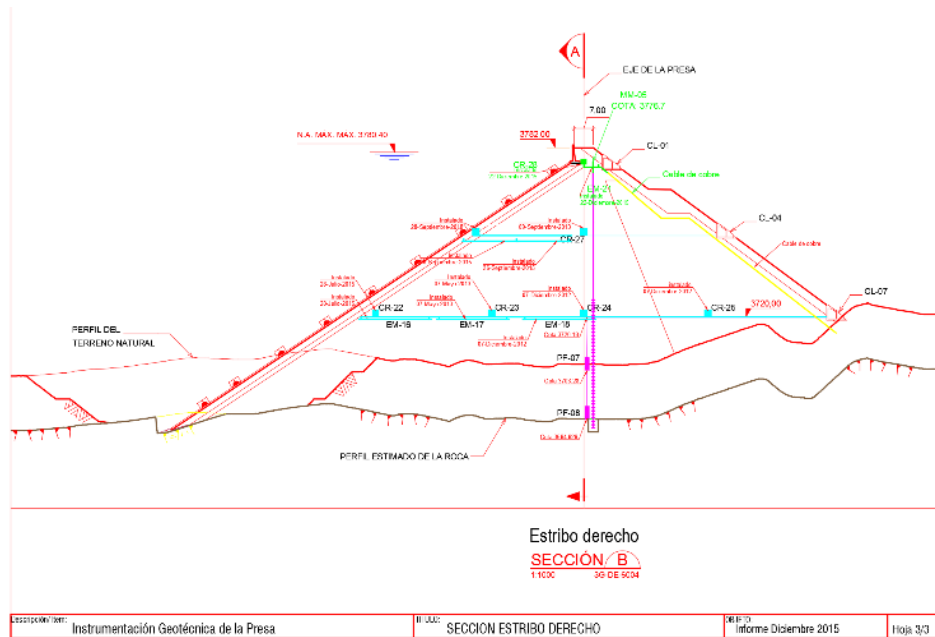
Sección estribo derecho de la presa con el detalle de los instrumentos instalados.
